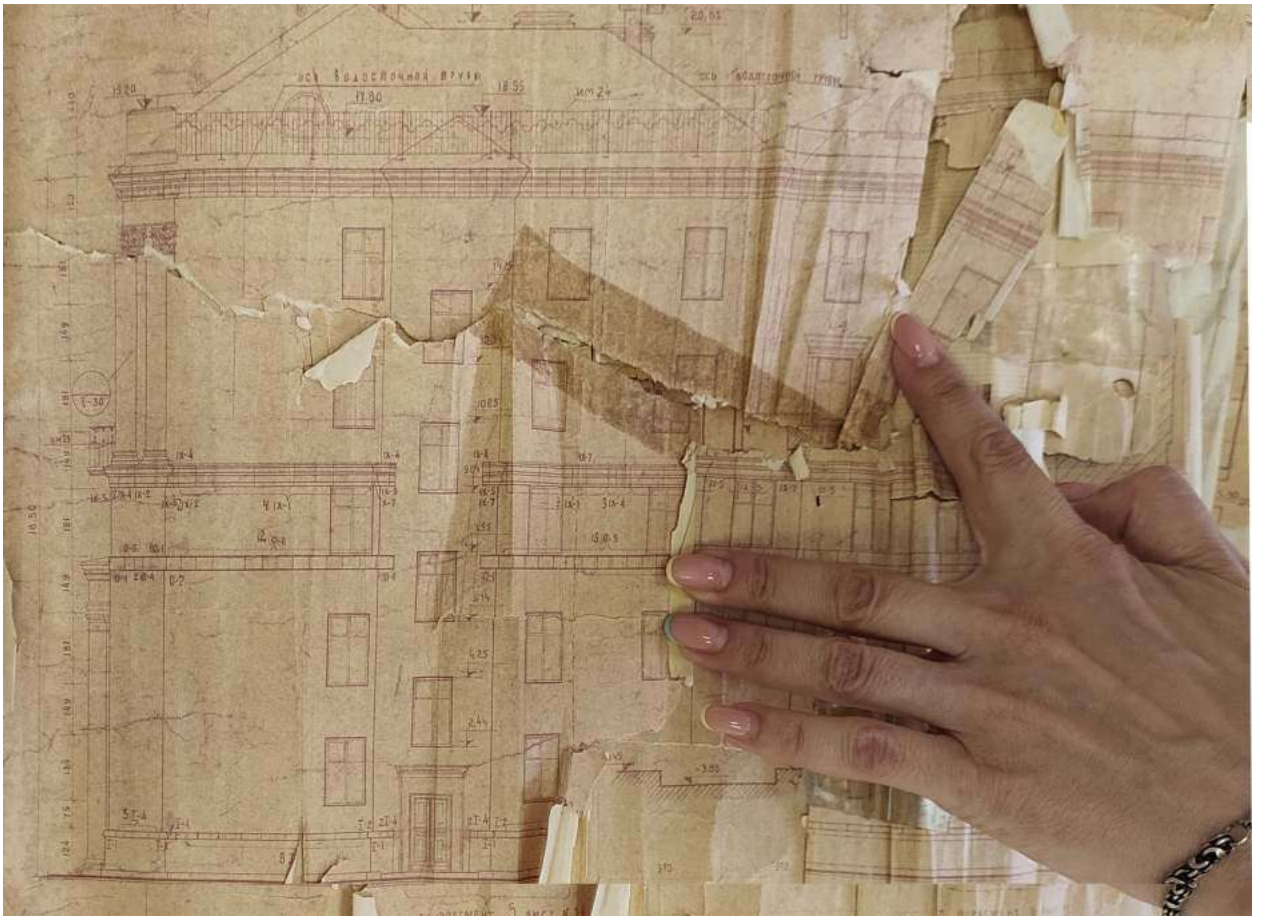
Фрагмент типового проекта № 1-409-2. Фрагмент главного фасада
